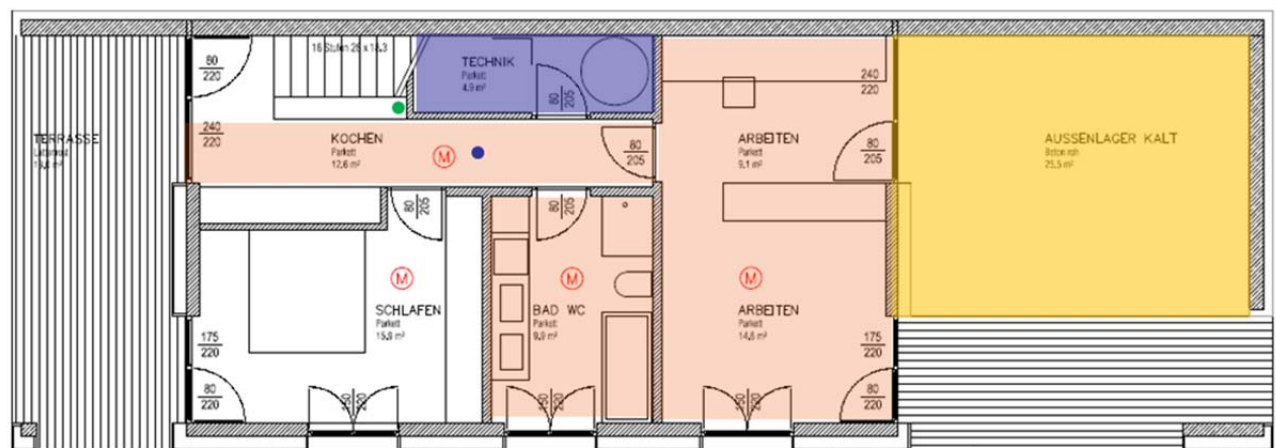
Grundriss des Untergeschosses, blau: Technikraum (Quelle: Einreichplan, Architekt DI T. Getzner)
